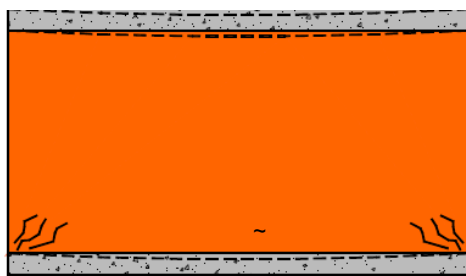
Fissuras provocadas pela deformação do elemento de suporte ser semelhante à viga superior [15]
